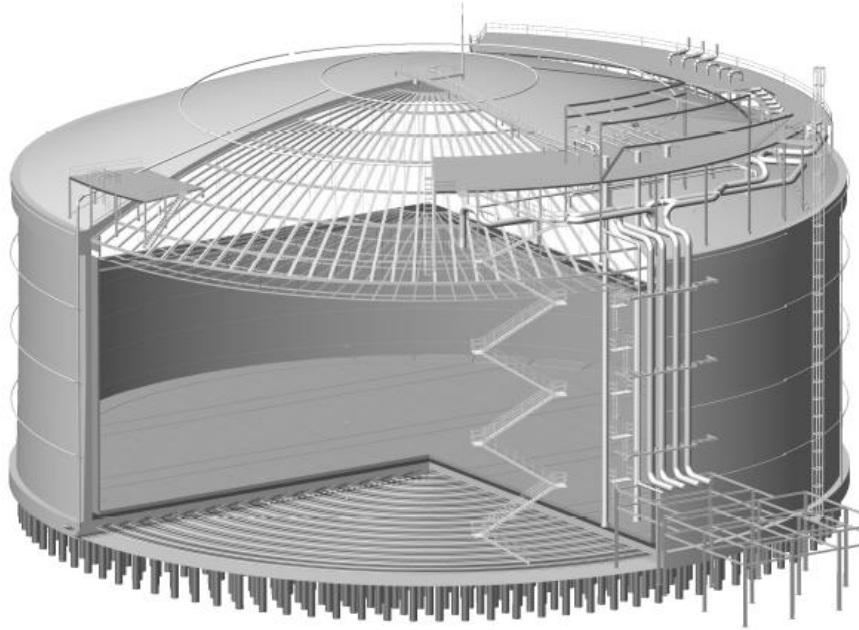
Çelik kubbeli (Steel roof) LNG tankı (Humphrey, 2009)
